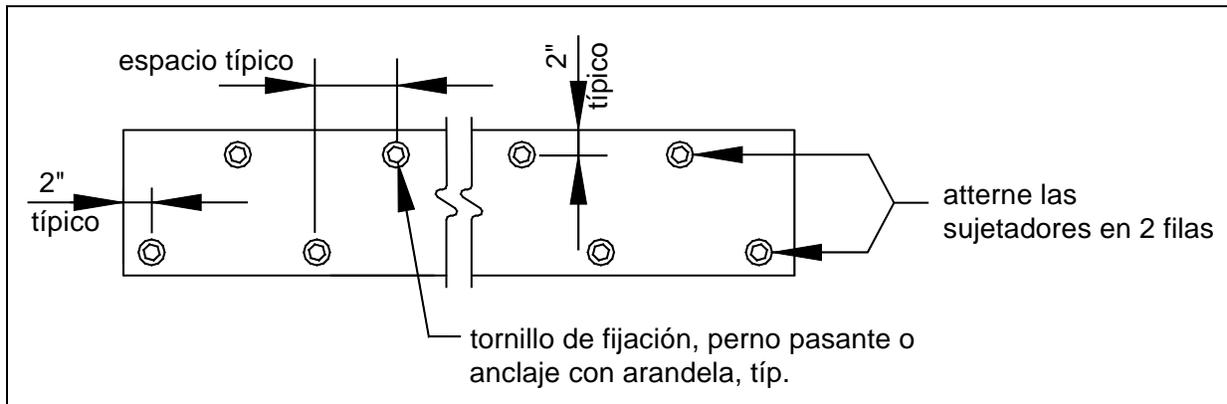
SEPARACIÓN DEL SOPORTE DE PUENTE PARA ENTABLONADO Y DISTANCIAS
